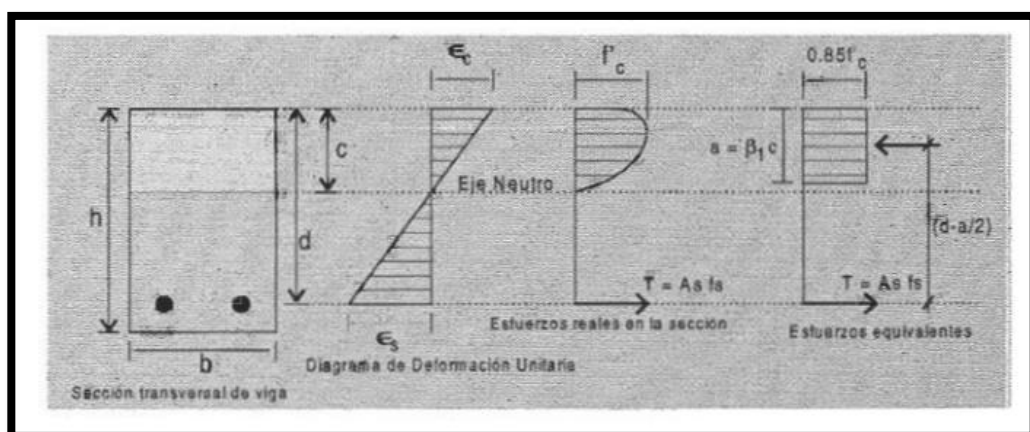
Cargas actuantes en sección de viga. Morales (2006).
